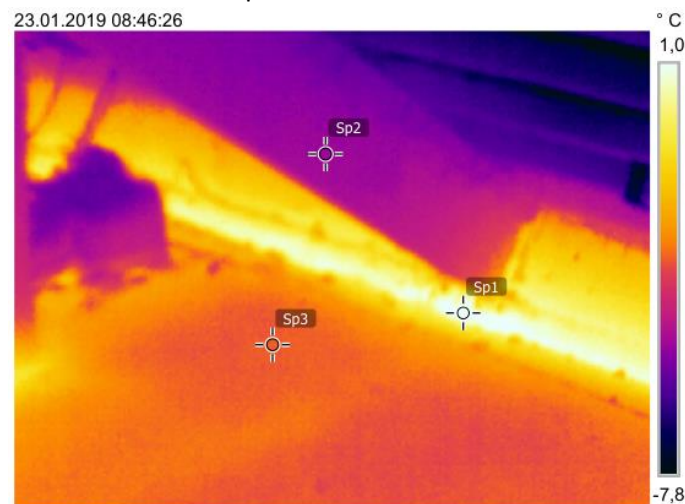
Dachboden konstruktive Wärmebrücke Deckendurchbruch Schornstein
